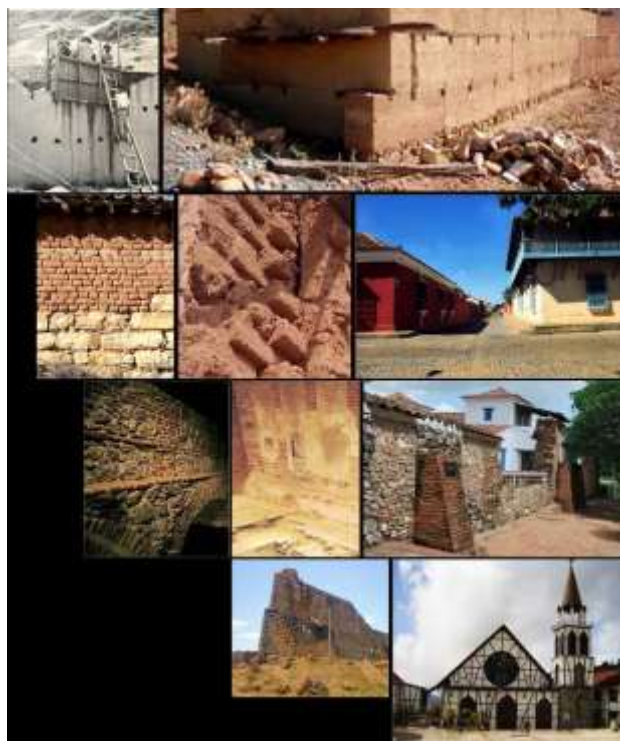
Sistemas constructivos de tradición española, transferidos tecnológicamente al Nuevo Mundo. Venezuela y sus experiencias arquitectónicas con adobe en Santa Ana de Coro; tapiales en Los Andes; mampostería de piedra en la casona del ingenio de San Mateo y en el Castillo de Araya; muro de sillería de piedra; muros de ladrillos en construcciones coloniales en la Guaira; y entramado de madera en la iglesia de la Colonia Tovar. Fuente: Contreras, Owen de Contreras y Contreras Owen (2015).
